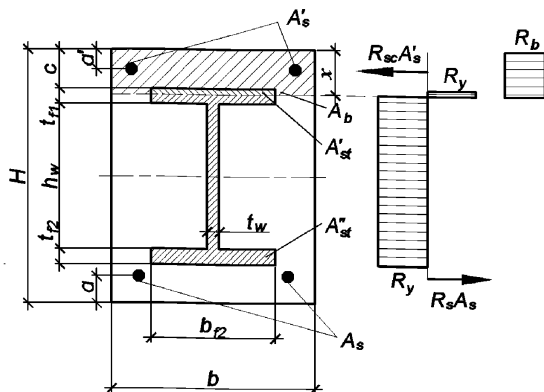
Случай, когда нейтральная ось пересекает сжатую (верхнюю) полку жесткой арматуры в обетонированной балке прямоугольного сечения
